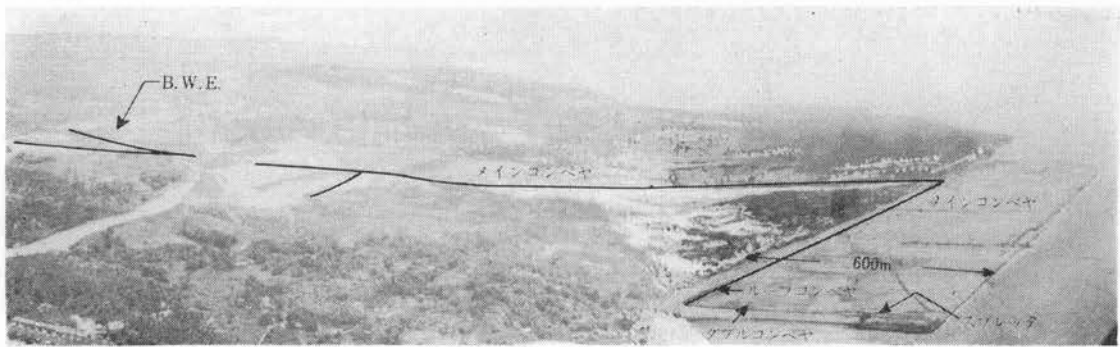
掘削地区 (Cut Site) および埋立地区 (Fill Site) のコンベヤ経路
